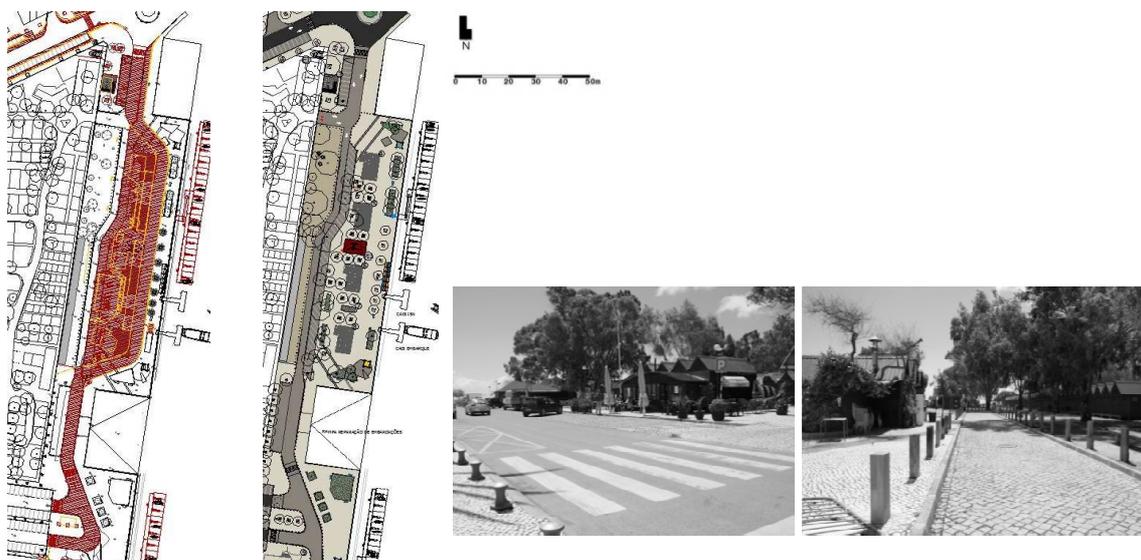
À esquerda, planta de “amarelos e vermelhos” e plano geral da frente ribeirinha nascente (base esc. 1/200); arruamento existente do lado nascente dos bares e, no mesmo local, lado poente. (Fotos:A.S)
